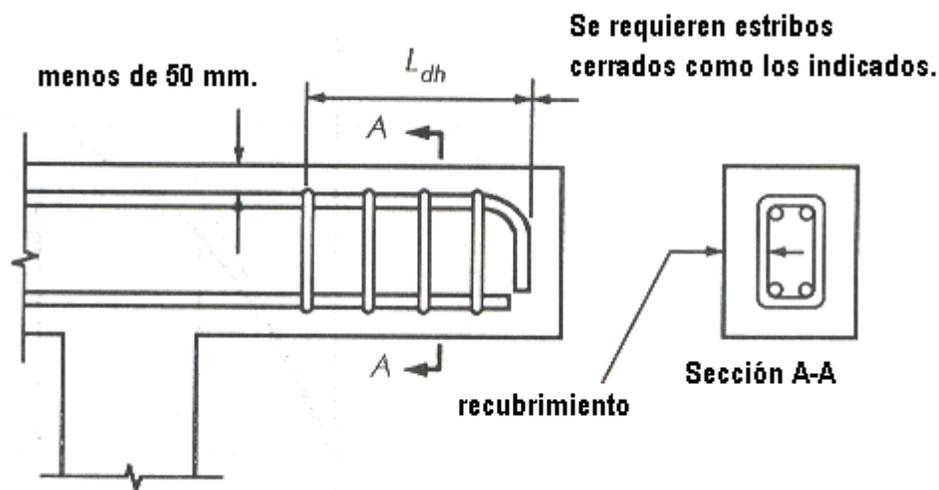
Requerimientos de los detalles de refuerzo
